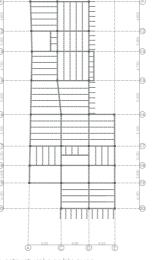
Primera Planta Alta, Anteproyecto Fuente: Autores, 2022
